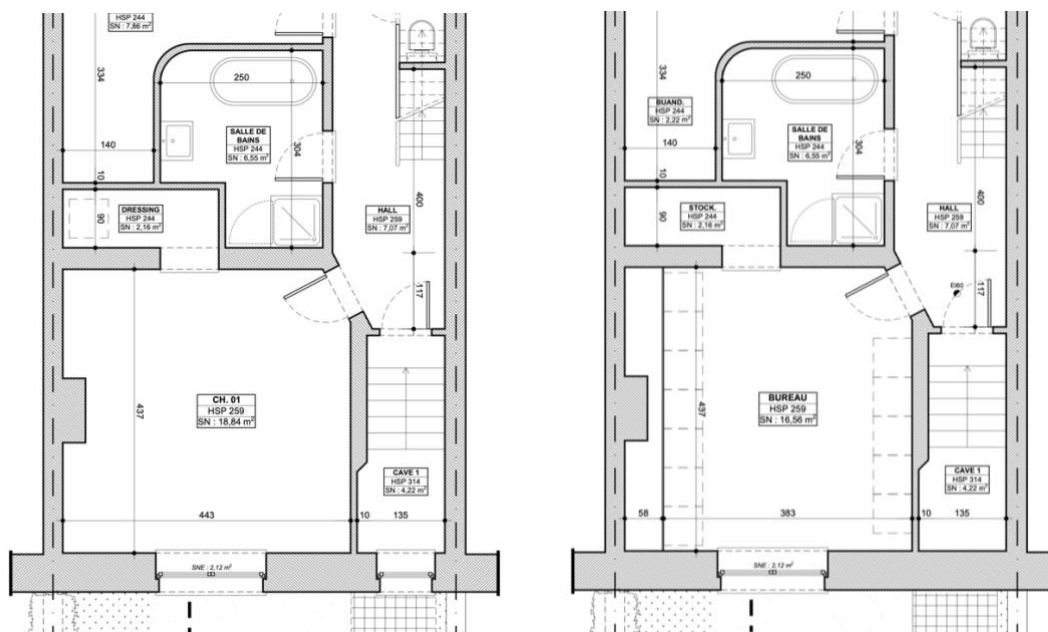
Transformation de la chambre principale en façade avant (à gauche) en bureau (à droite).
